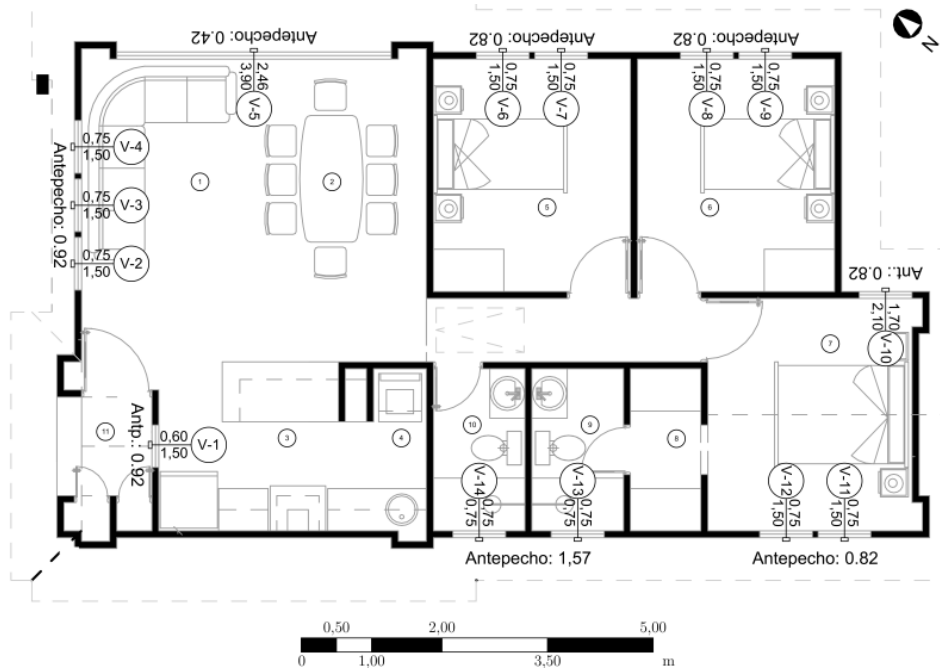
Plano de ventanearías del proyecto para Sr. Gerardo Campoverde.
